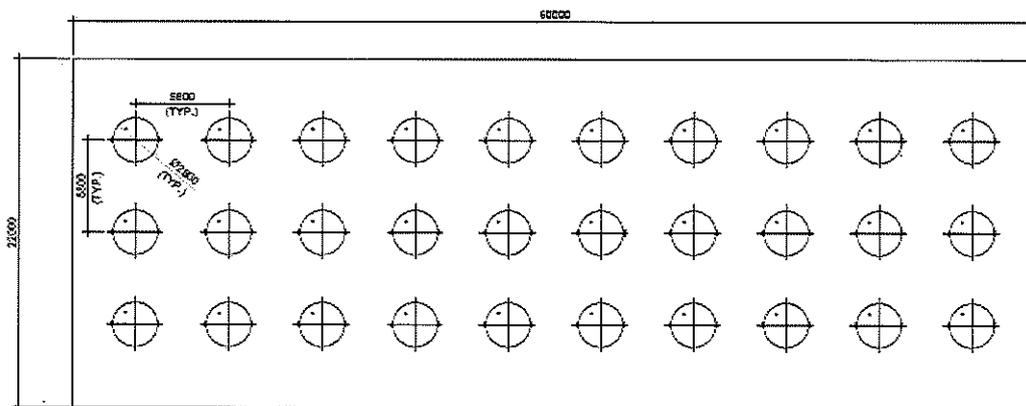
Vista en Planta del sistema de almacenamiento de hidrógeno
